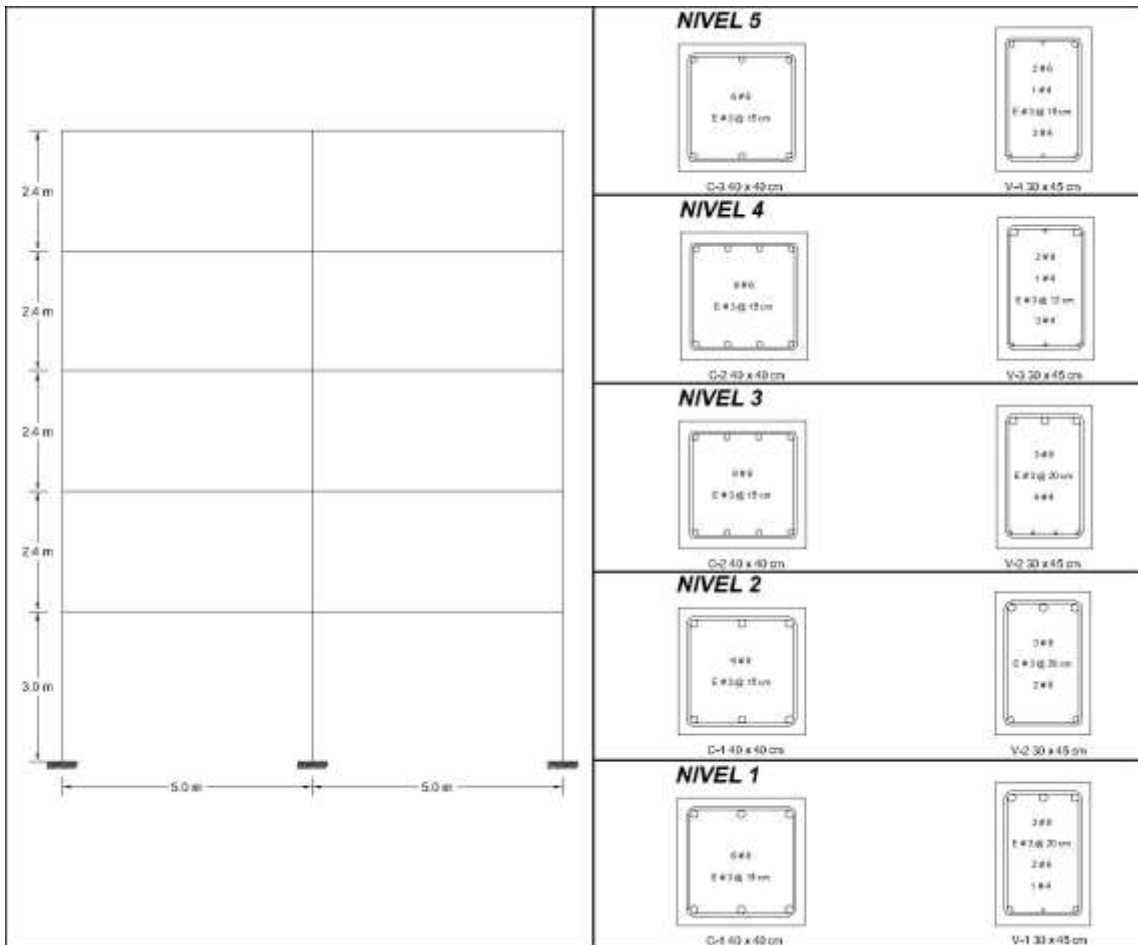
Armado de vigas y columnas para MCR de 5 con MDL diseñadas con el RCDF-2004 (GDF, 2004a).
